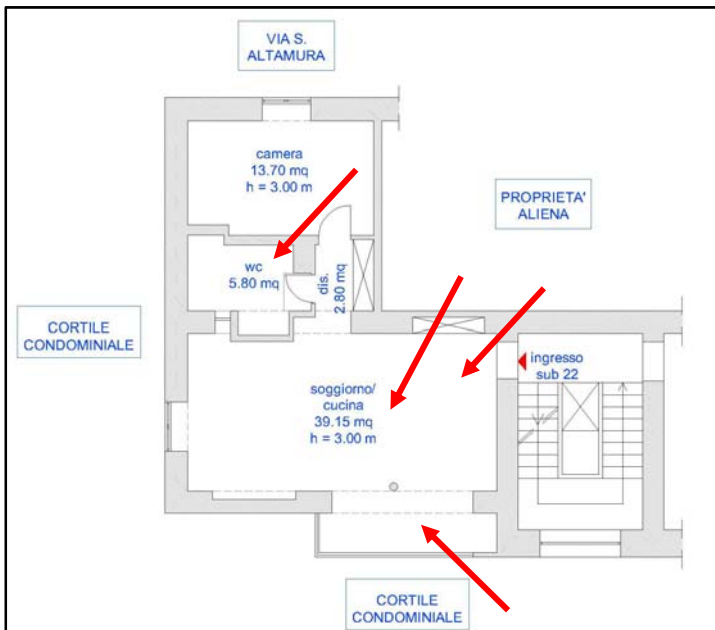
Plan. stato dei luoghi appartamento del 11/12/2020
